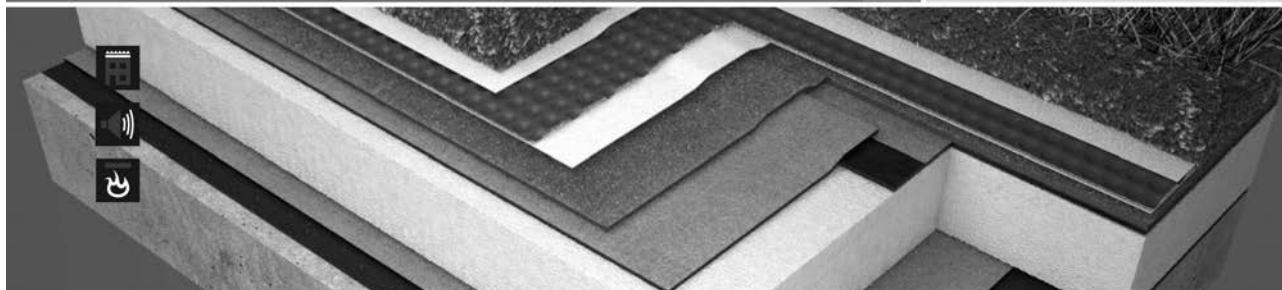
Detail ukončení hydroizolace na stěně (skladba DEKROOF 09-A)
